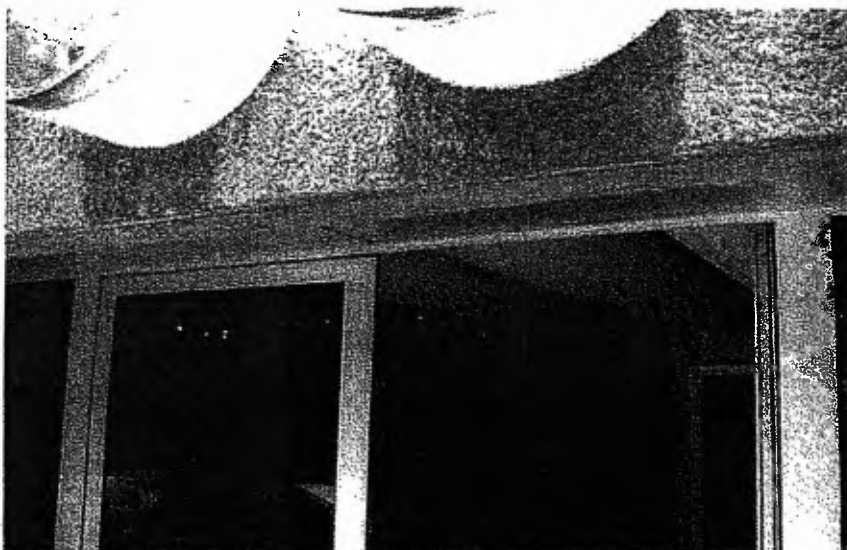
Demi-buses au-dessus et en plafond de l'entrée (à l'extérieur)
